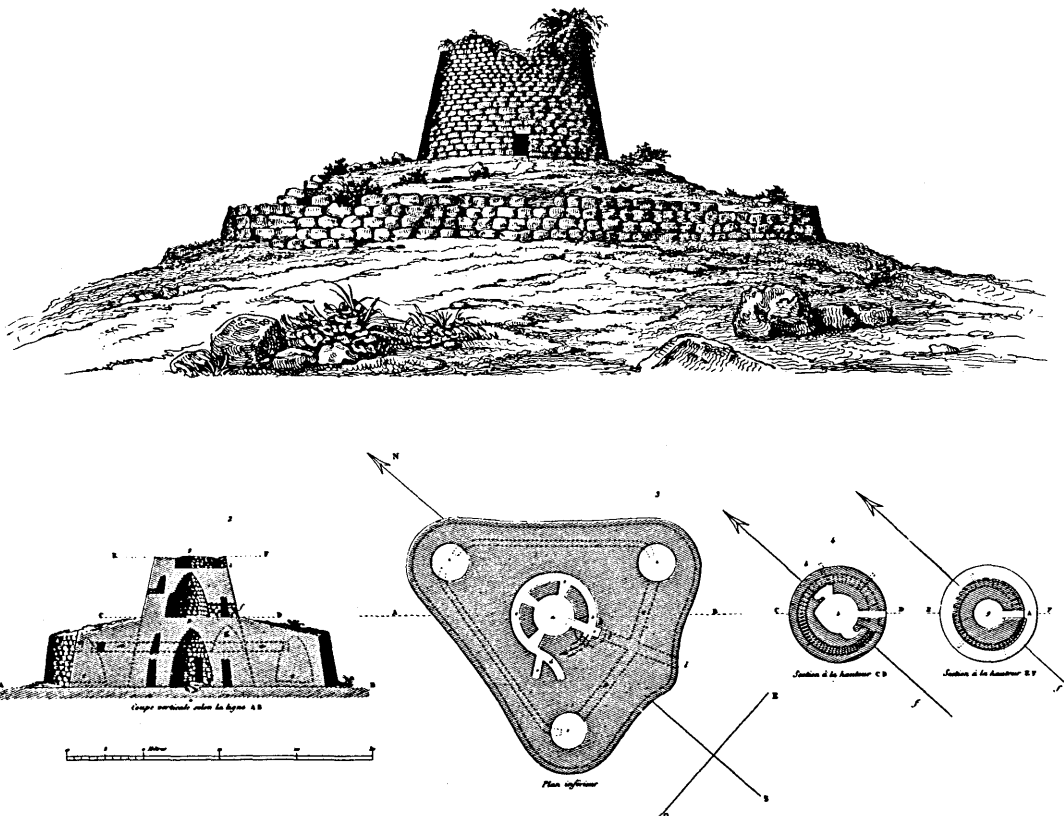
Pianta, sezione e prospetto del nuraghe S. Antine nel rilevamento del Lamarmora.
